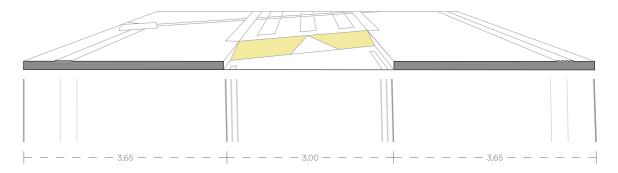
Sección B-B: Propuesta para la calle Lope de Vega.
